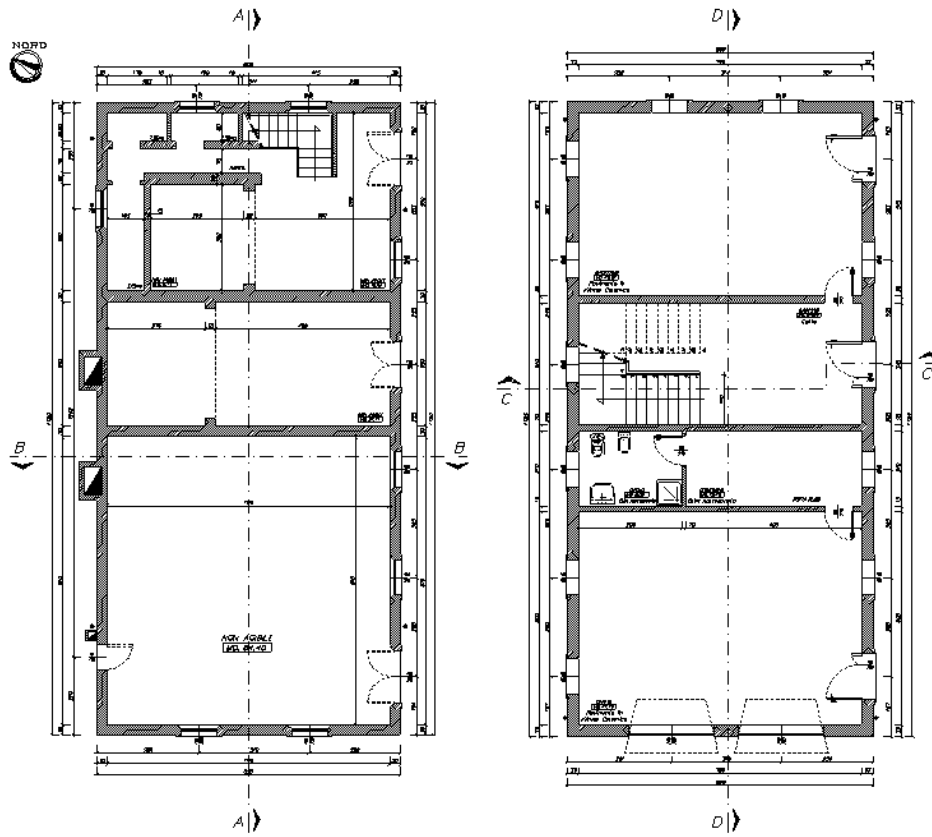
Confronto stato di fatto e di progetto: piante murature piano terra
